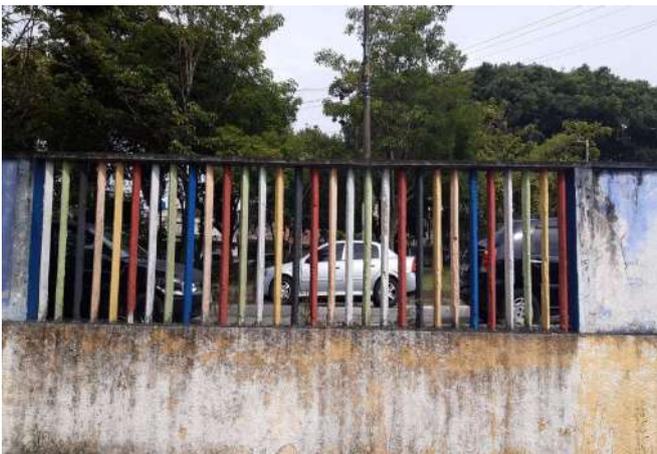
RESTAURAÇÃO DOS PONTALETES DE CONCRETO DO MURO DO ESTACIONAMENTO
